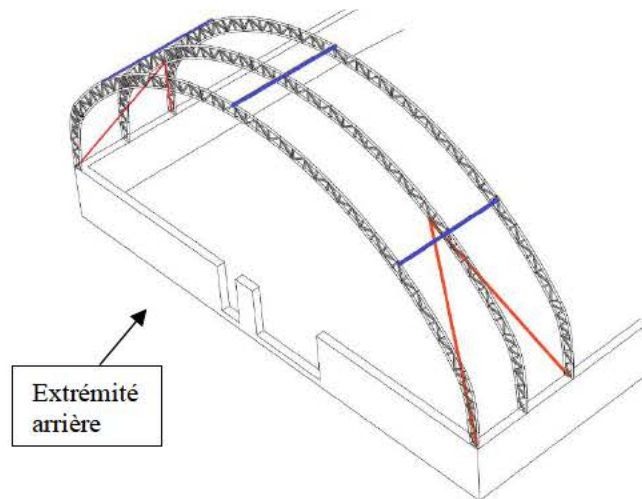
Haubans installés entre les arches 1 à 3
